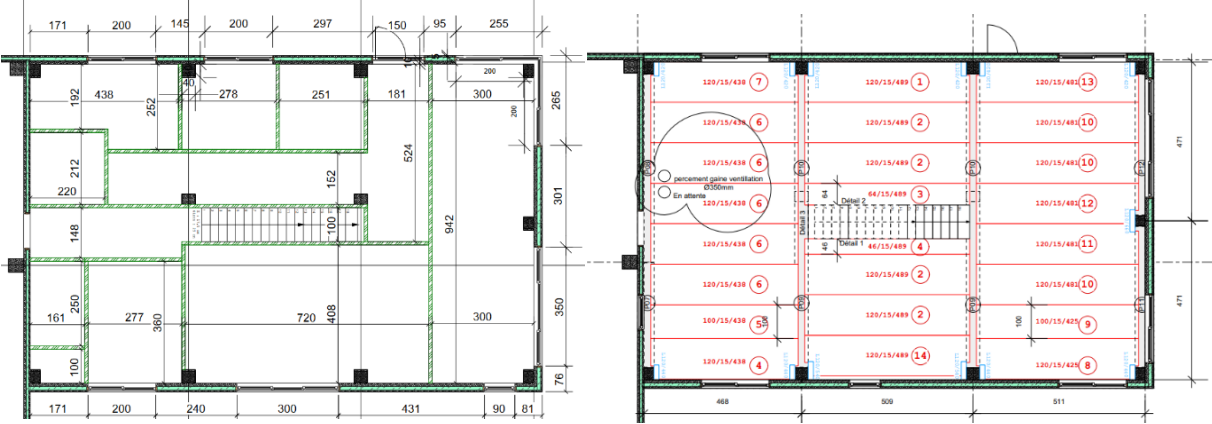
PLAN DE STRUCTURE DU REZ-DE-CHAUSSEE
